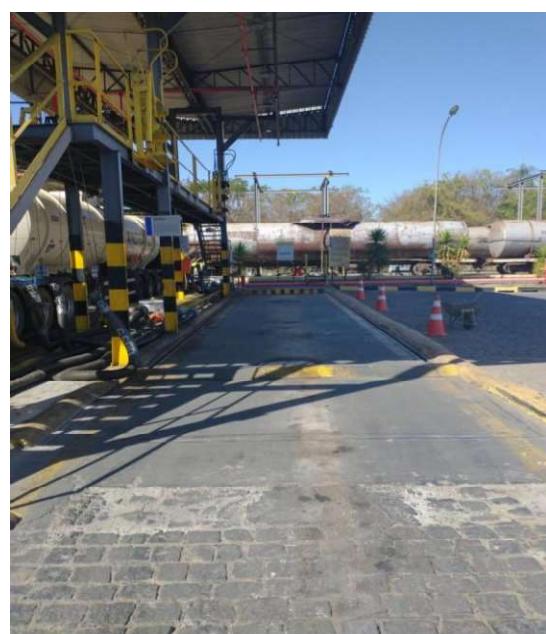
Plataforma de descarregamento de caminhões tanque.
